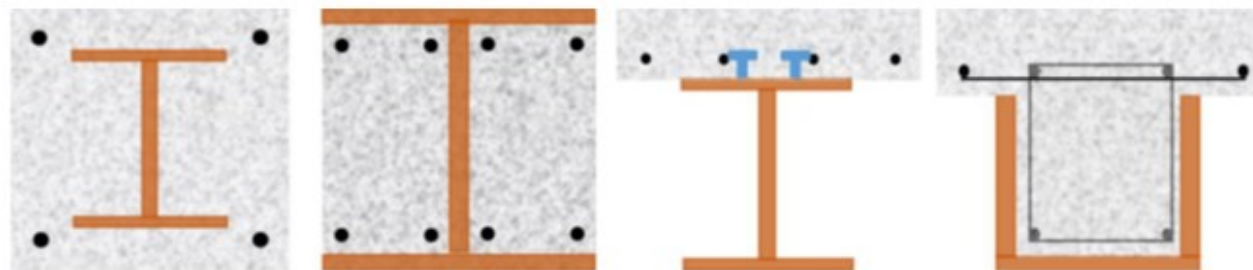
Tipos esquemáticos de vigas mistas Aço-Concreto
